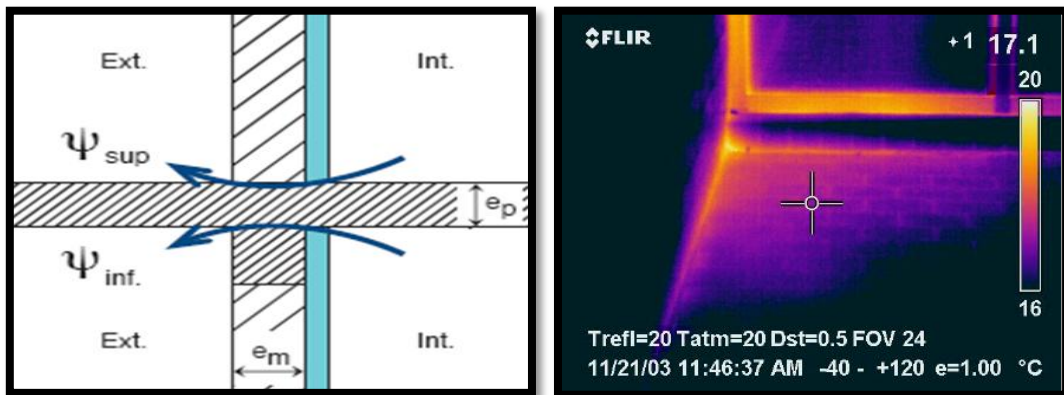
Ligação da Fachada com Varanda; fonte: RCCTE (2006); Finn M. (2004)
